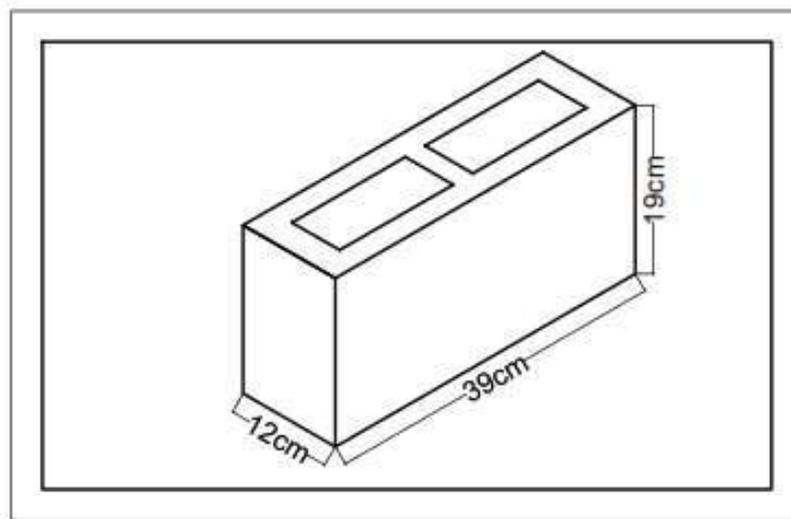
Bloque de concreto hueco.* Fuente: Elaboración propia (2021).
